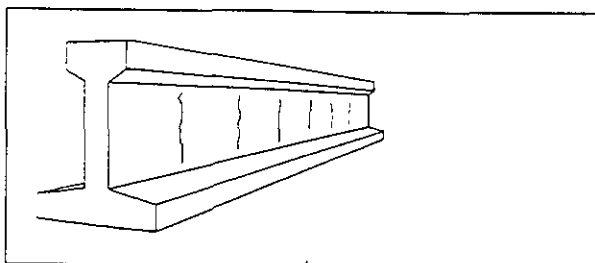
Grietas de contracción, alma de trabe I
